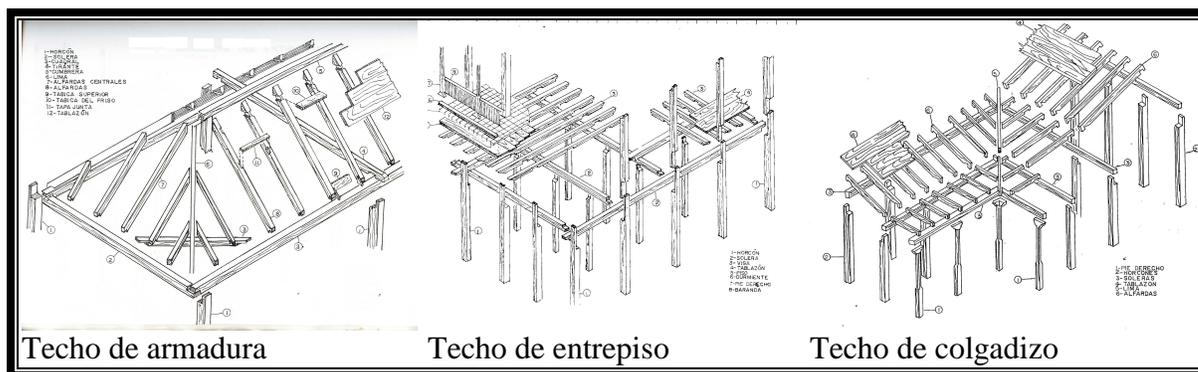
Estructura de los techos de las viviendas <sup>84</sup>.
